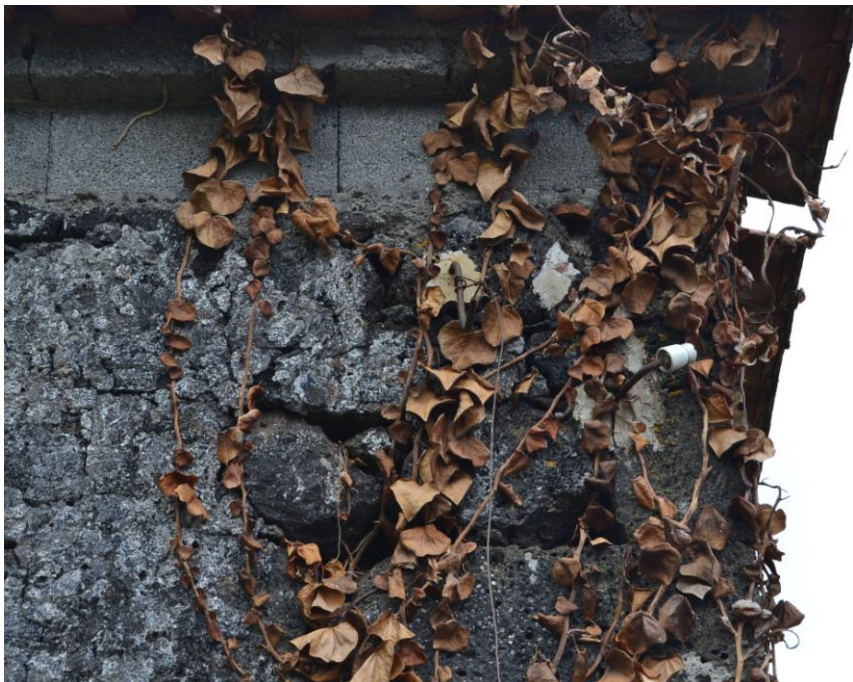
Falhas evidentes nas fachadas e cobertura
